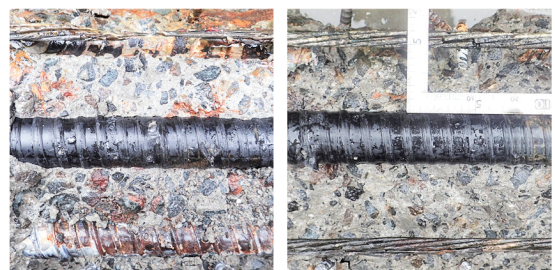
鋼材腐食状況 (左 : A1, 右 : B)
